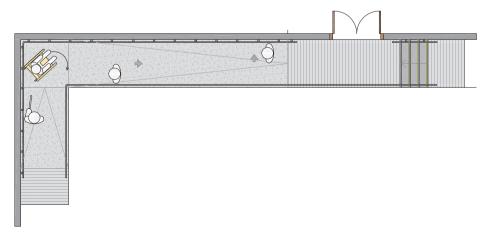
Planta de una rampa en esquina y detalle de encuentro con escalera y puerta de acceso a otra dependencia.
